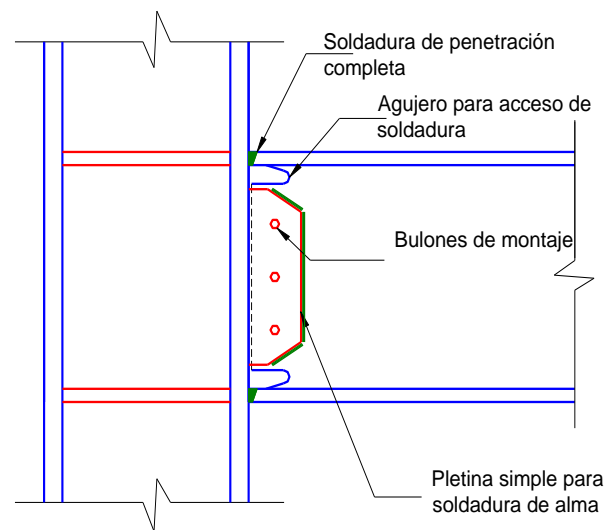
Conexión ala soldada no reforzada-almá soldada.
